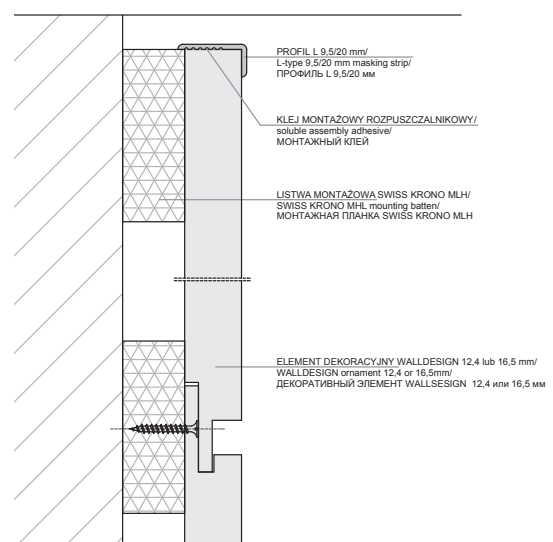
Montaż pierwszego elementu za pomocą kleju – montaż w pionie
